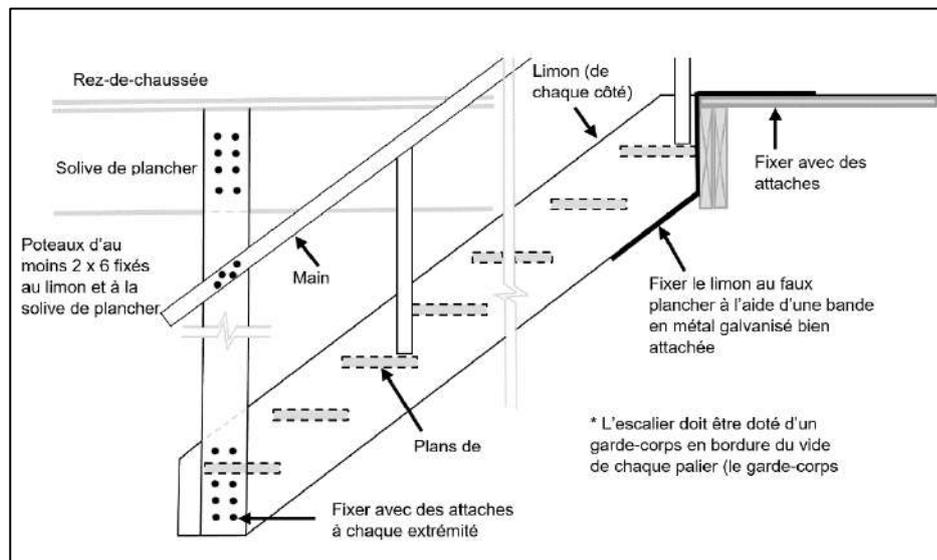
assemblage escalier préfabriqué. Source : PRE-ENGINEERED BUILDING-pdf
